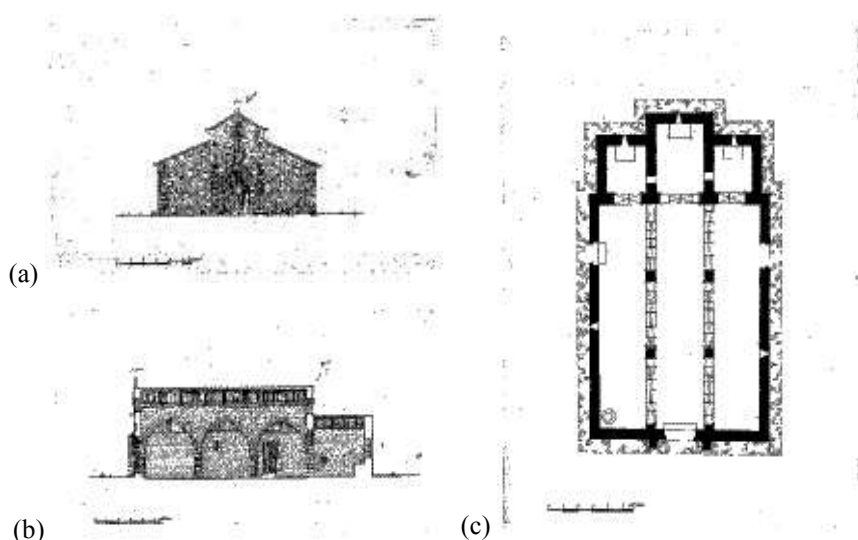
Peças desenhadas [Fonte: DGEMN]: (a) alçado frontal; (b) corte longitudinal; (c) planta.
